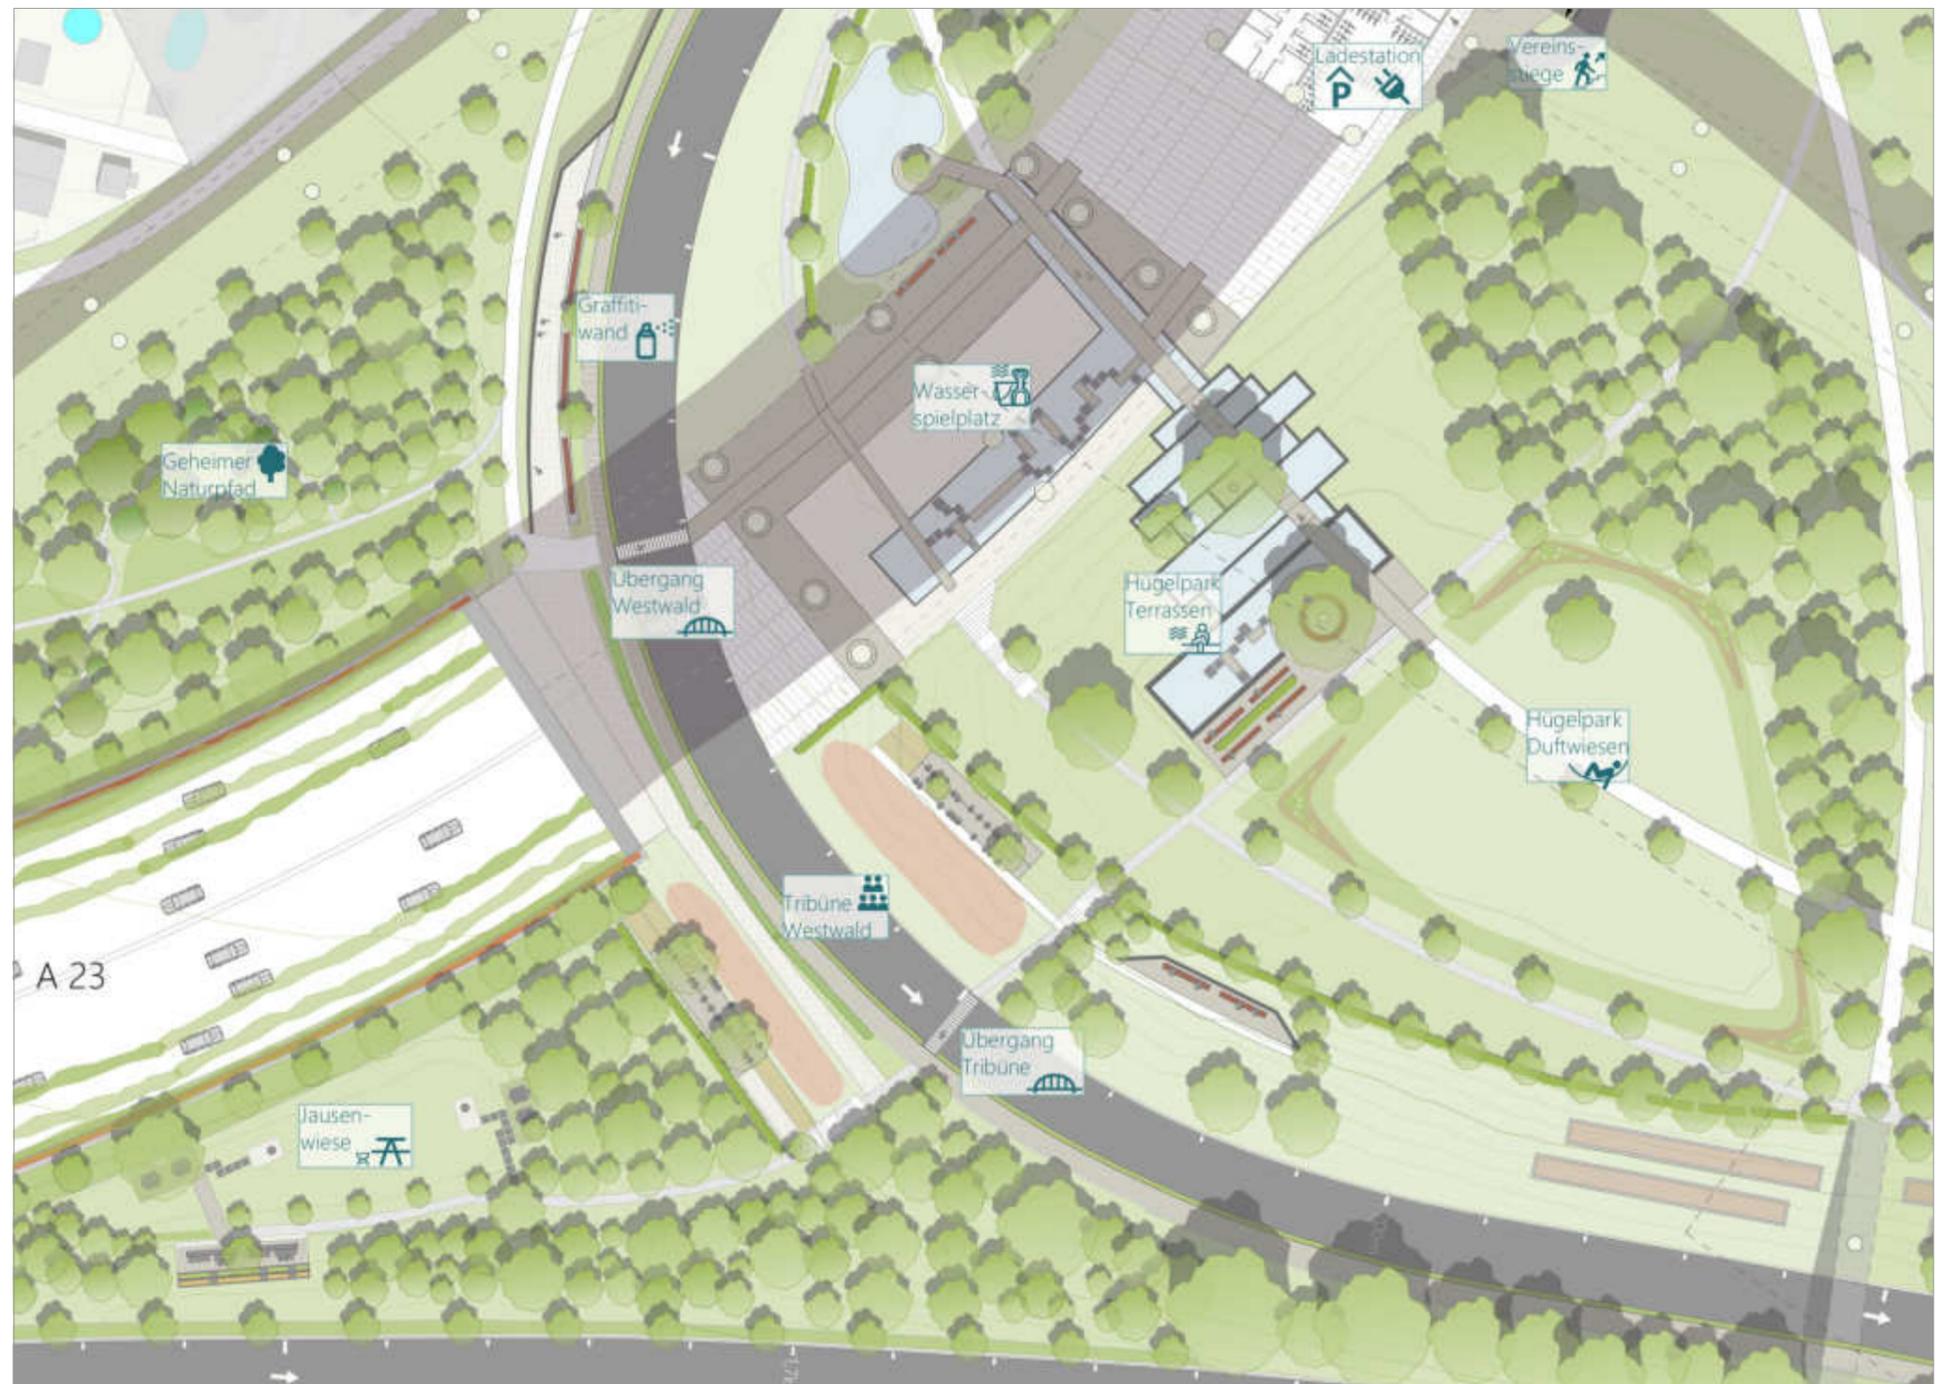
Ausschnitt Lageplan, Hügelpark - eigene Darstellung, o.M.
